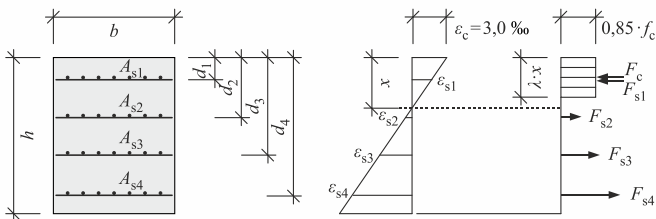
Biegebemessung mehrlagig mikrobewehrter Betonbauteile nach [ACI-1993]
